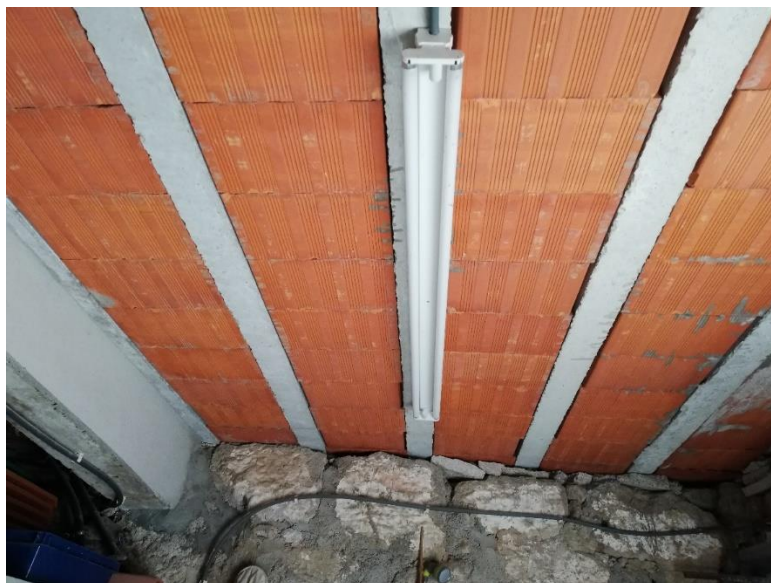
Estrutura da laje aligeirada da Casa das Varandinhas constituída por vigotas tipo Maprel e tijolo de 15 cm de espessura, vista da cave
